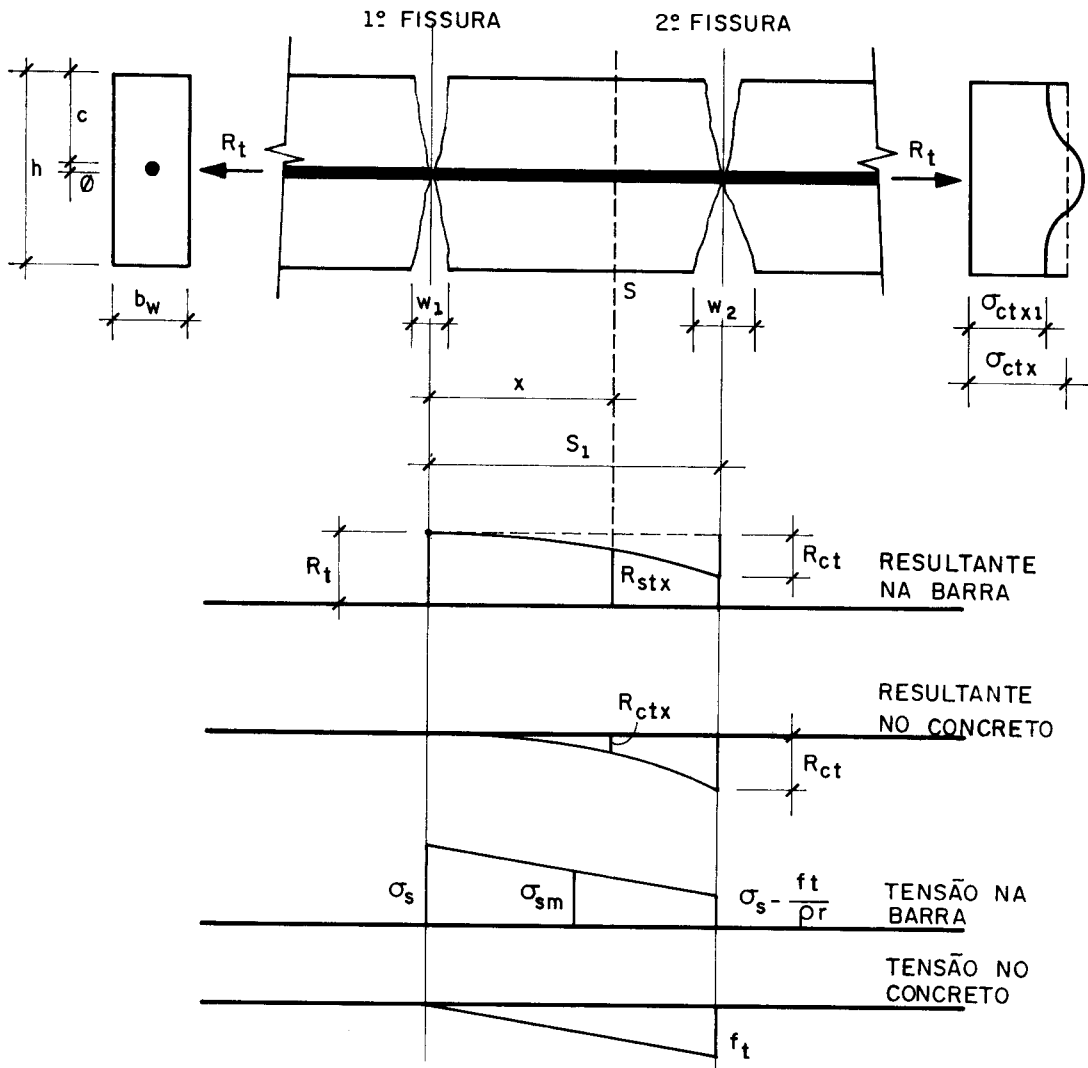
FISSURAÇÃO SISTEMÁTICA
